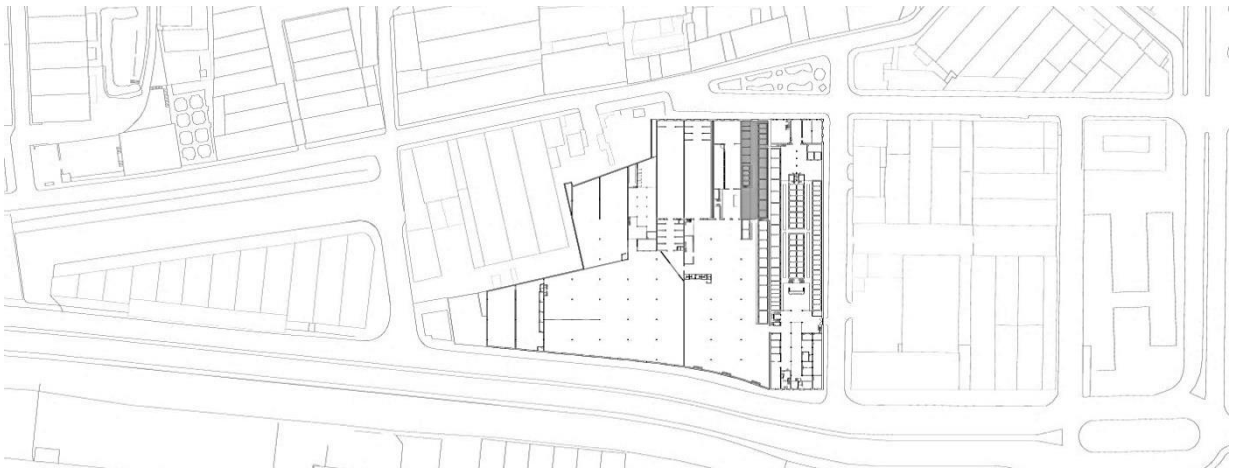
Planta de levantamento fotográfico piso térreo – Armazém 4.
